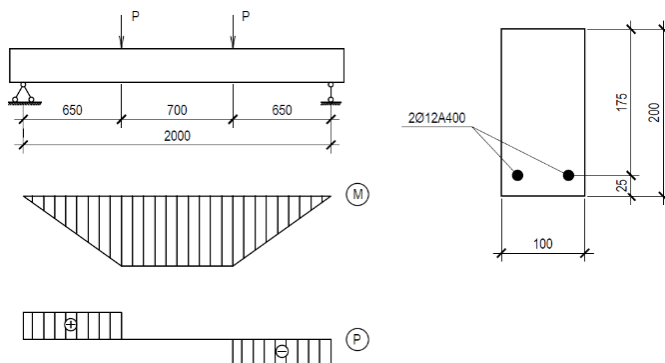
Расчетная схема и поперечное сечение рассчитываемой балки
